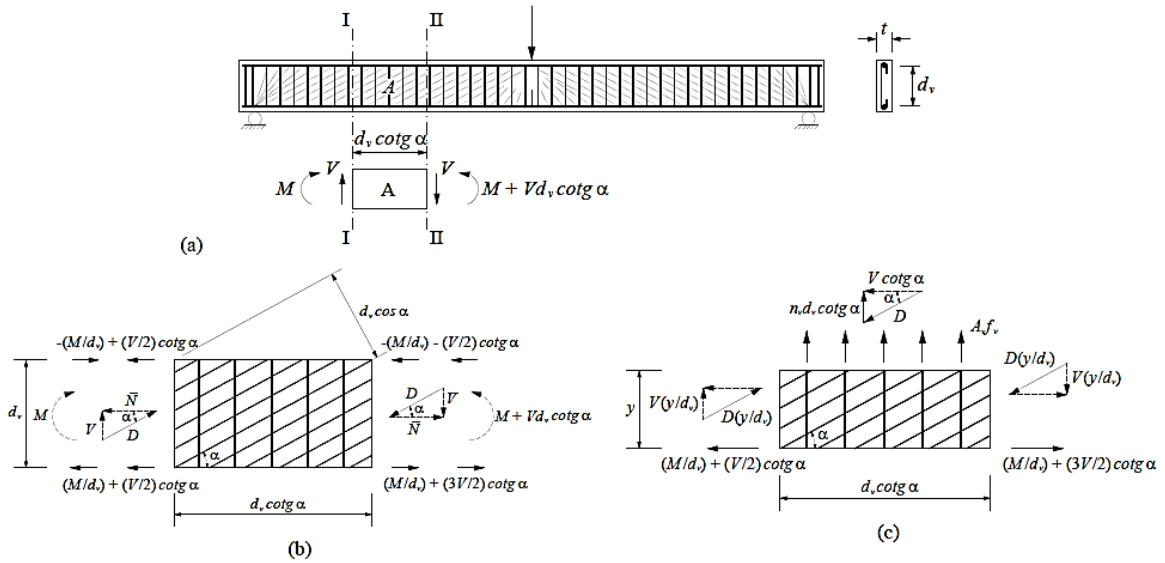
Análise de uma viga com base no modelo de treliça plana [56].
